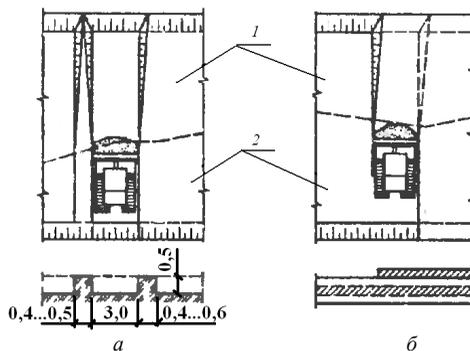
Схемы резания и перемещения грунта бульдозером: *a* – траншейный; *б* – послойный; 1 – насыпь; 2 – выемка
